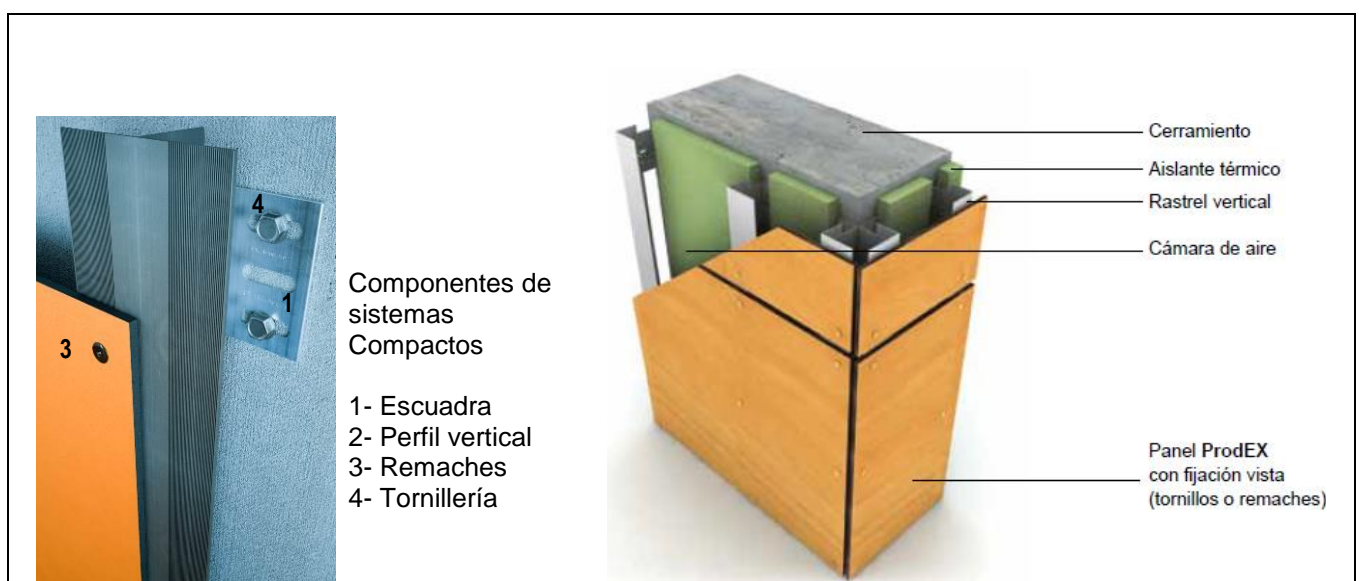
24 Detalles de la subestructura de la (FVL) -A Detalle en sección de los elementos que componen la subestructura, esquema de funcionamiento, -B Detalle de perfil y elementos de fijación (C21 y C22)
